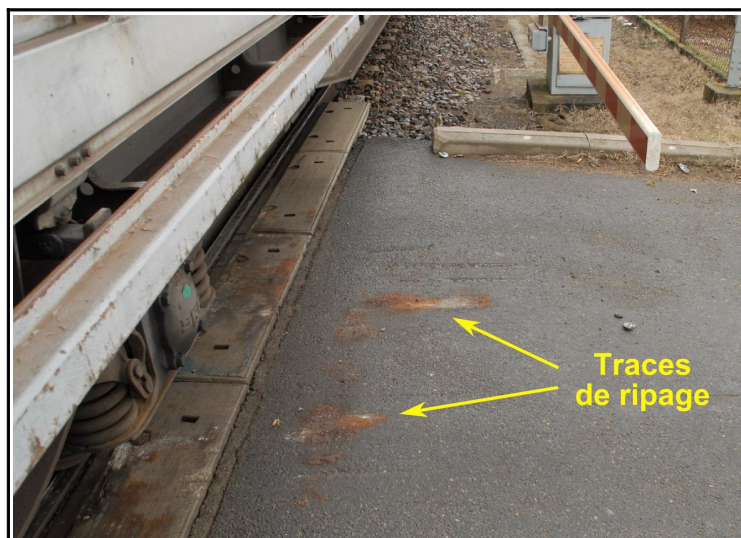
Vue rapprochée des traces de ripage sur la chaussée
